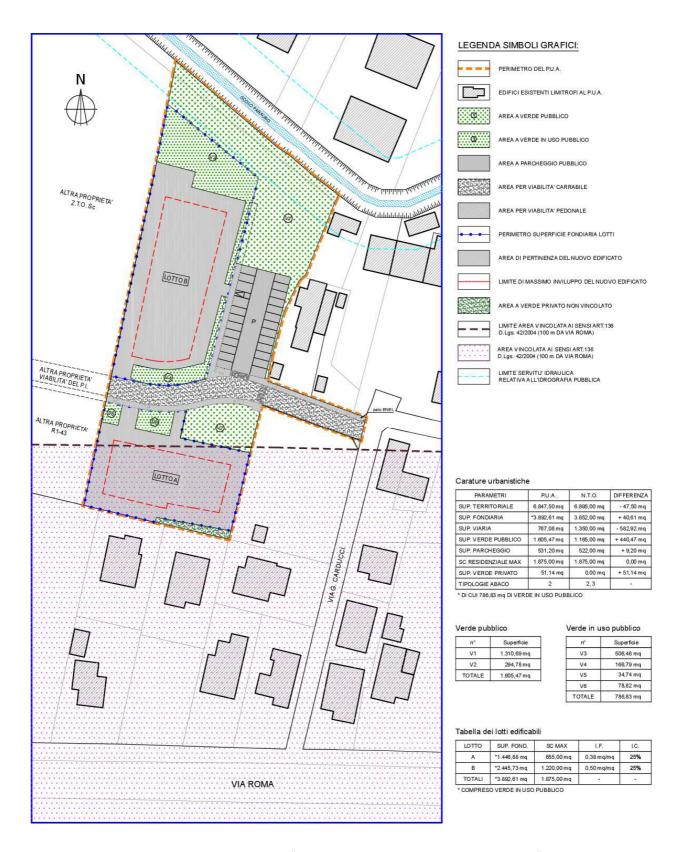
Estratto da tav. 4 – "Planimetria generale – Zonizzazione e vincoli"
